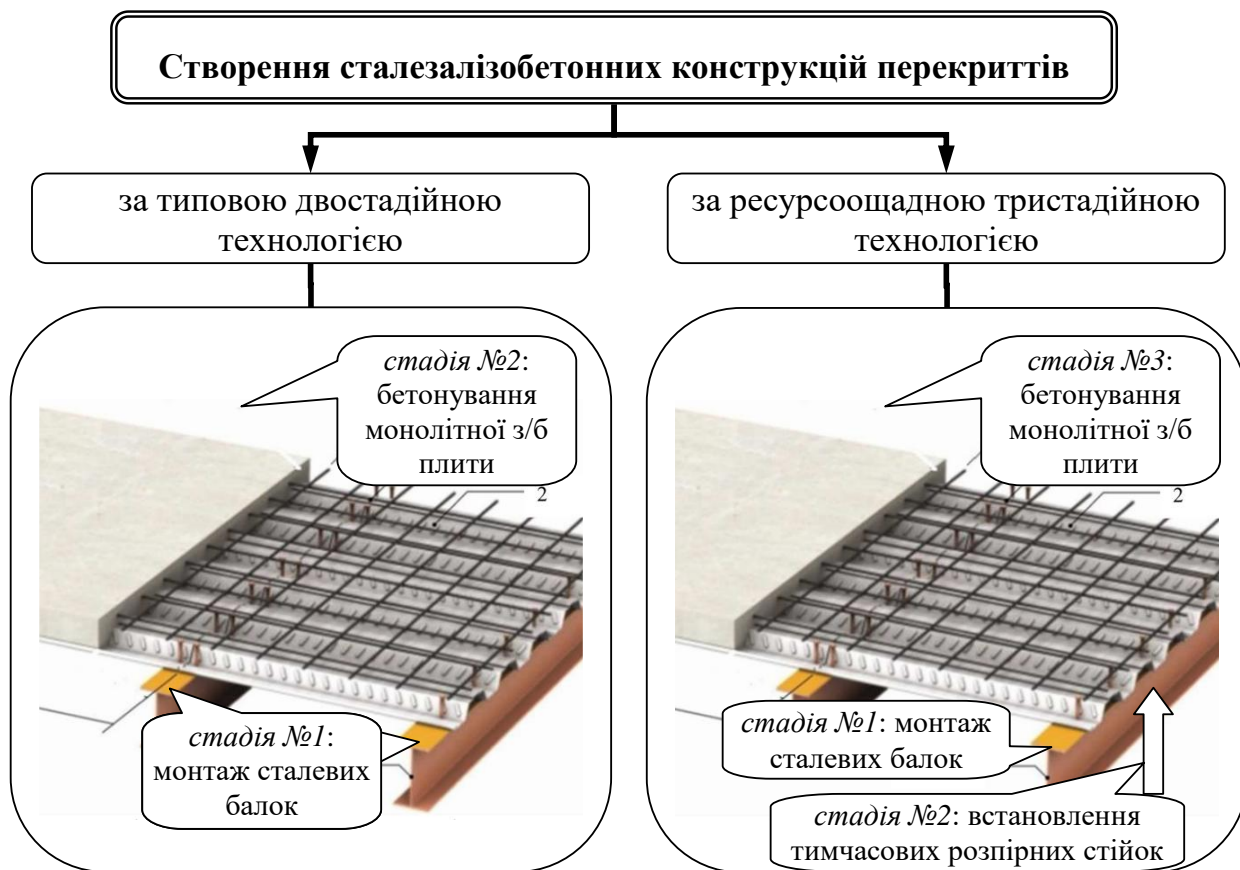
Багатостадійна технологія створення сталезалізобетонних перекриттів
